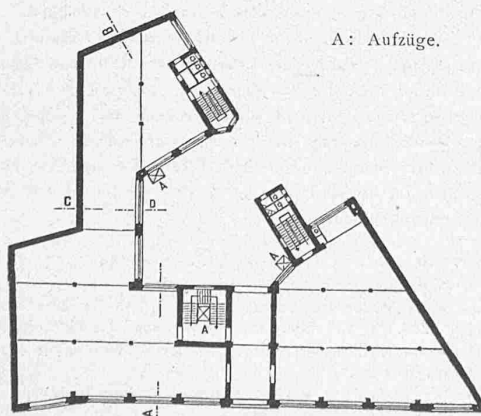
Erdgeschoss-Grundriss 1:800.
